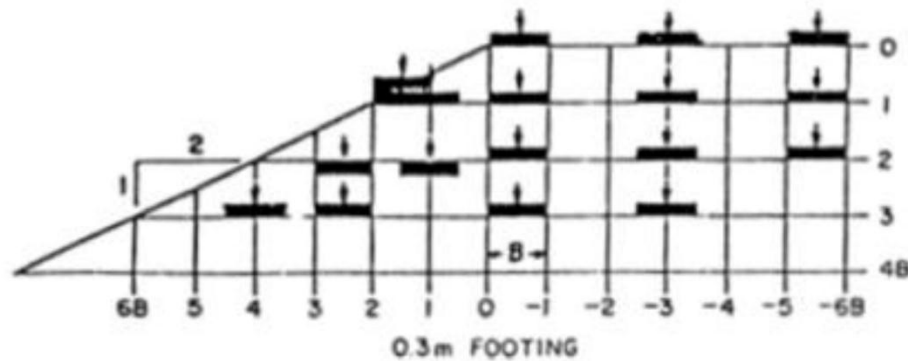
Emplacement des fondations (Bauer et al.1981)
